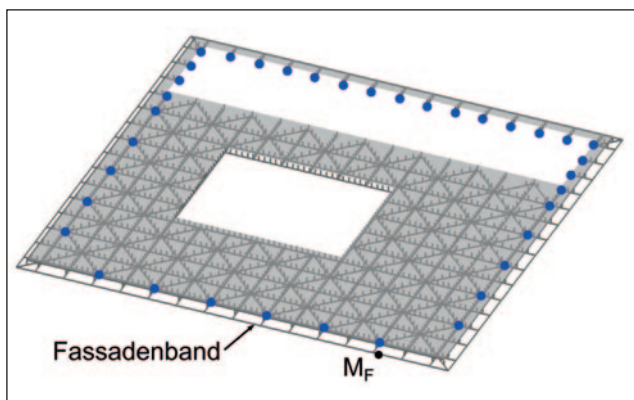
Dachkonstruktion: Beplankter Trägerrost aus Holz mit Kennzeichnung des Ortes des maßgebenden Bemessungsmoments M_F des Fassadenbandes und der betrachteten Auflager (blaue Punkte)
